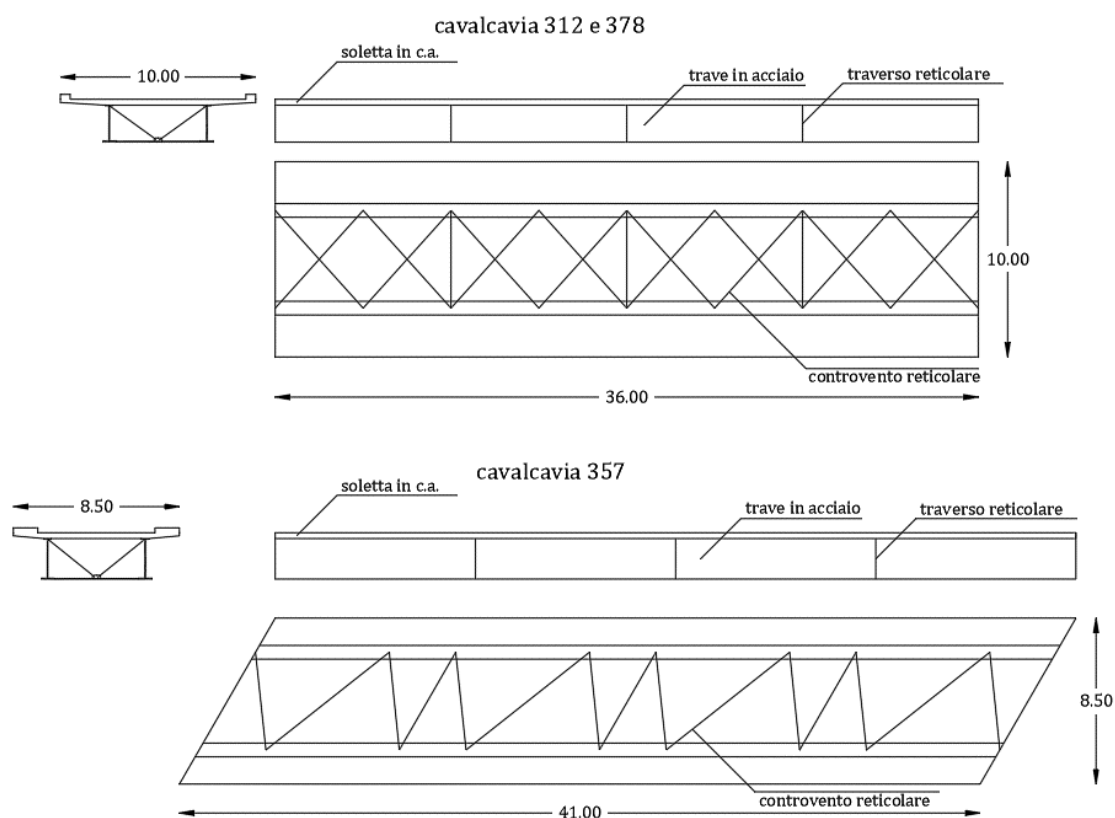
Sezione, prospettiva e pianta dell'impalcato centrale
